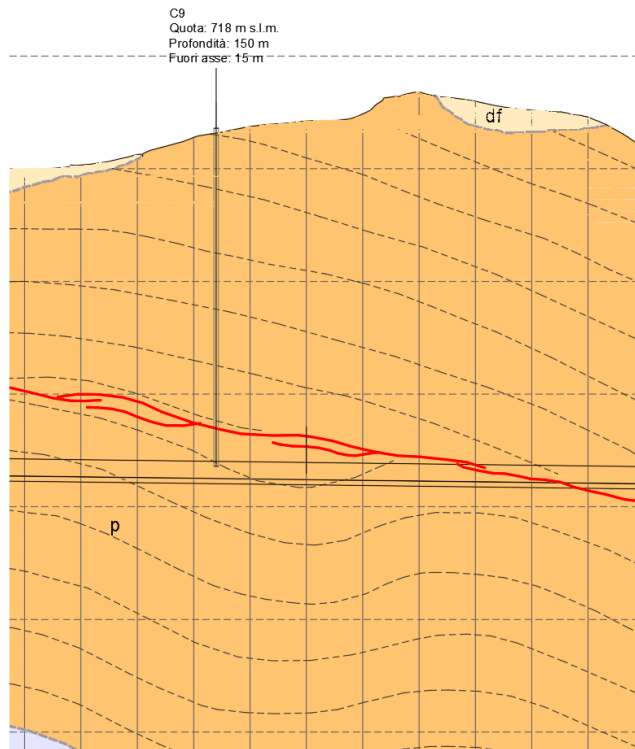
Estratto profilo geomeccanico longitudinale Galleria Gardena
